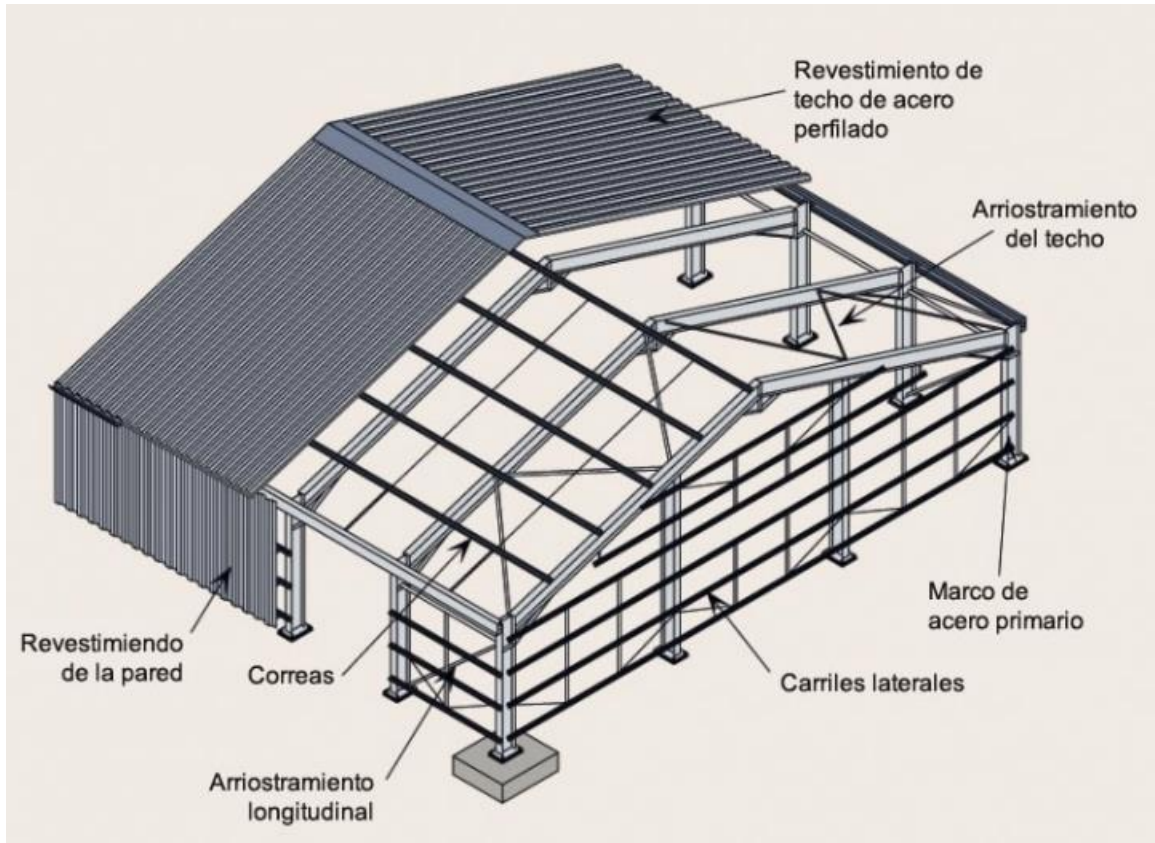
Pórtico estructural para un edificio típico de una sola planta (fuente: ingeniería & construcción s.a.)
